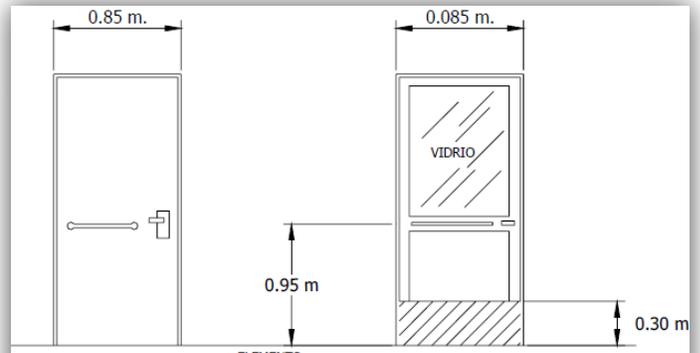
Fuente: manual de eliminación de barreras arquitectónicas MIDEPLAN/ accesos
